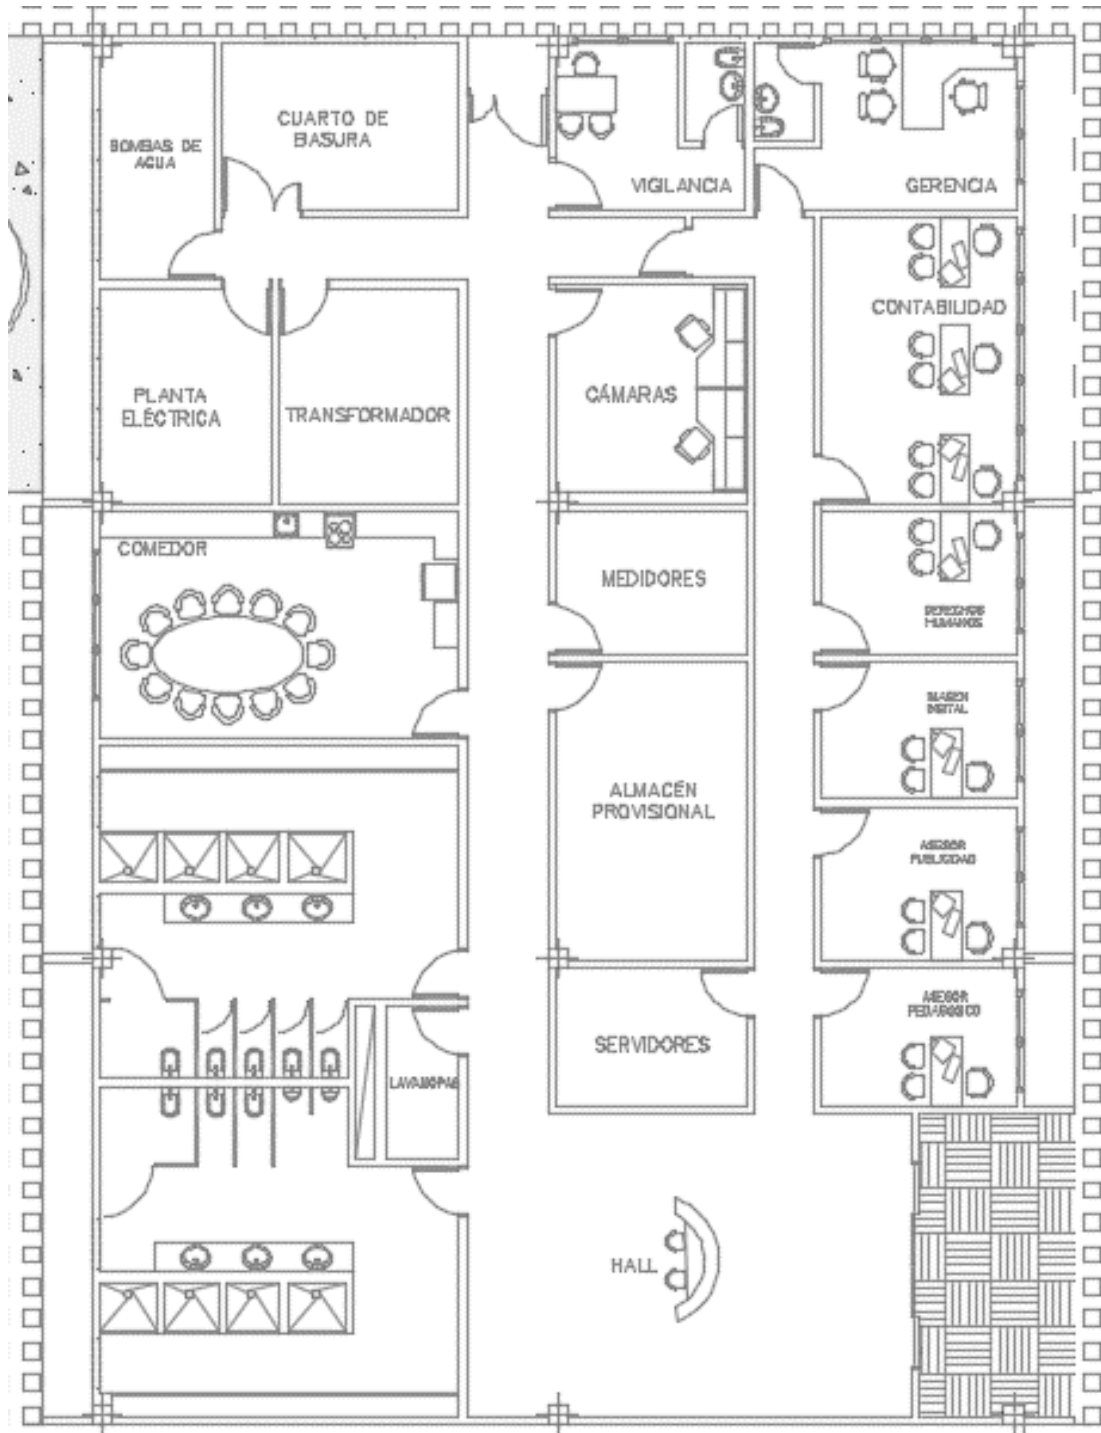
Planta Baja Módulo Administrativo. Fuente: Propia autoría. (2018)
